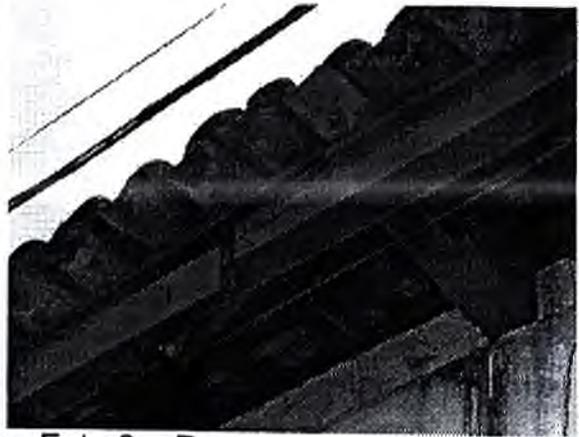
Arruinamento no interior do prédio      Foto 8 – Peça rompida da cobertura
